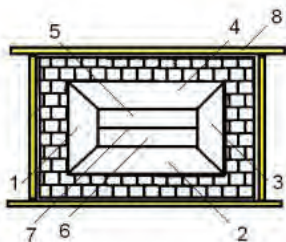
Схема предохранительной разрушающейся конструкции ограждения зданий.
